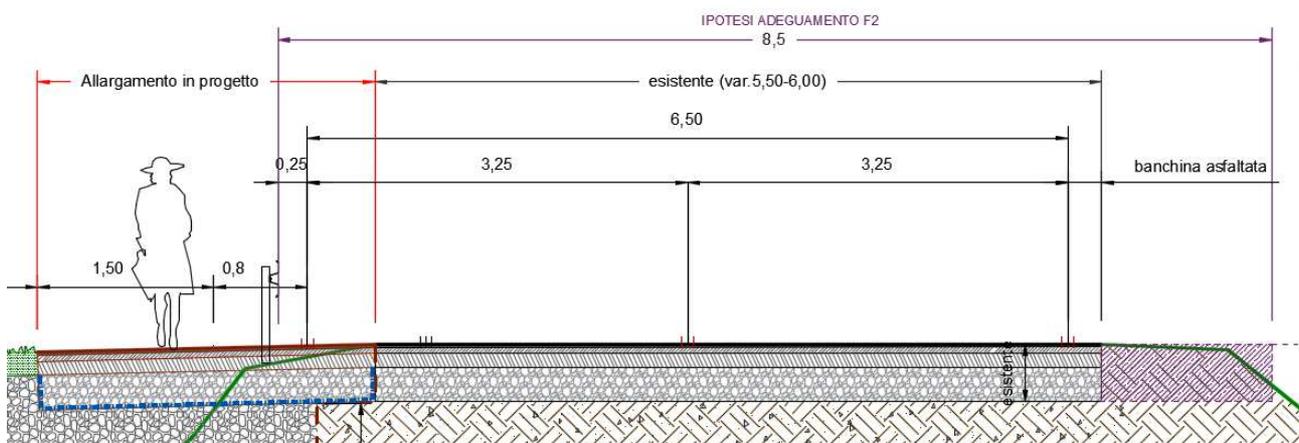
Sezione tipo di adeguamento dell'infrastruttura e dell'allargamento in progetto.
